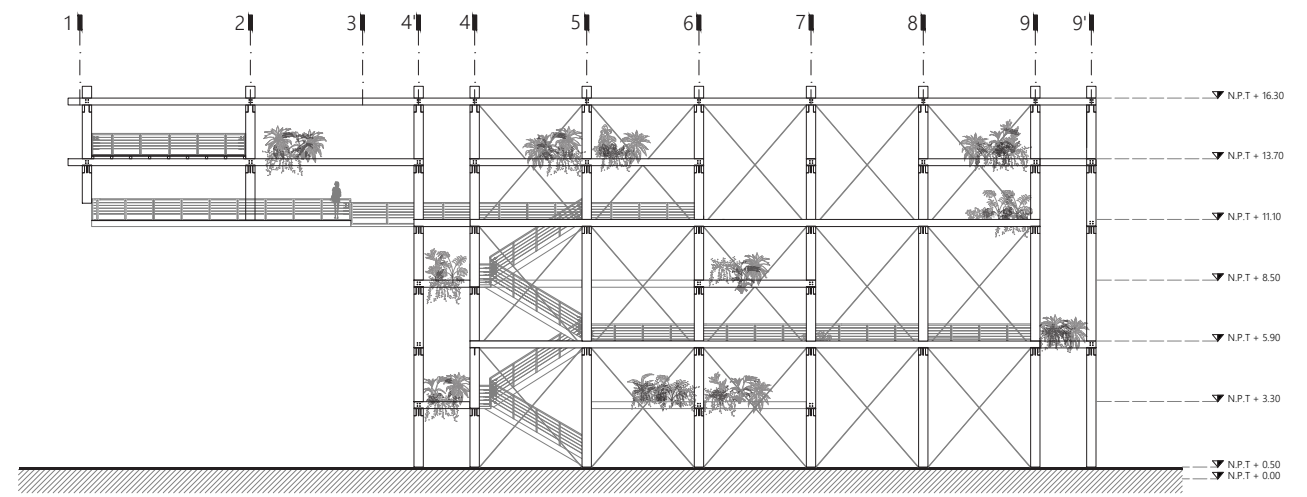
Fachada oriente. Fuente: Elaboración propia.
